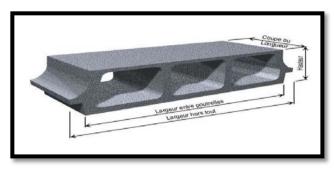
Le hourdis. Source : Disponible sur : < http://www.seac-gf.fr/planchers-poutrelles-plancher-hourdis-plancher-seac-gf.pdt1.p6.php> (Consulté le 20/12/2016).
